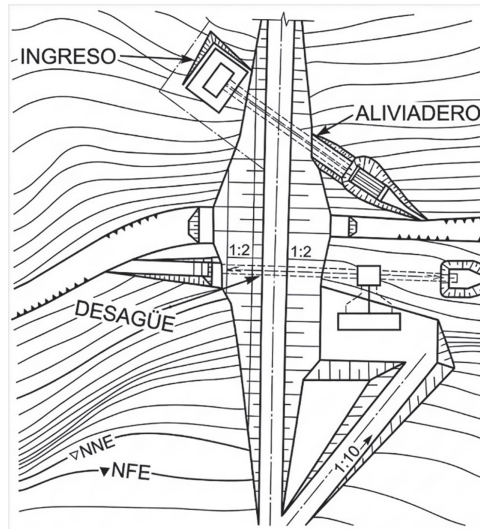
Planta de un sistema de carga pequeña con presa de material del lugar.
